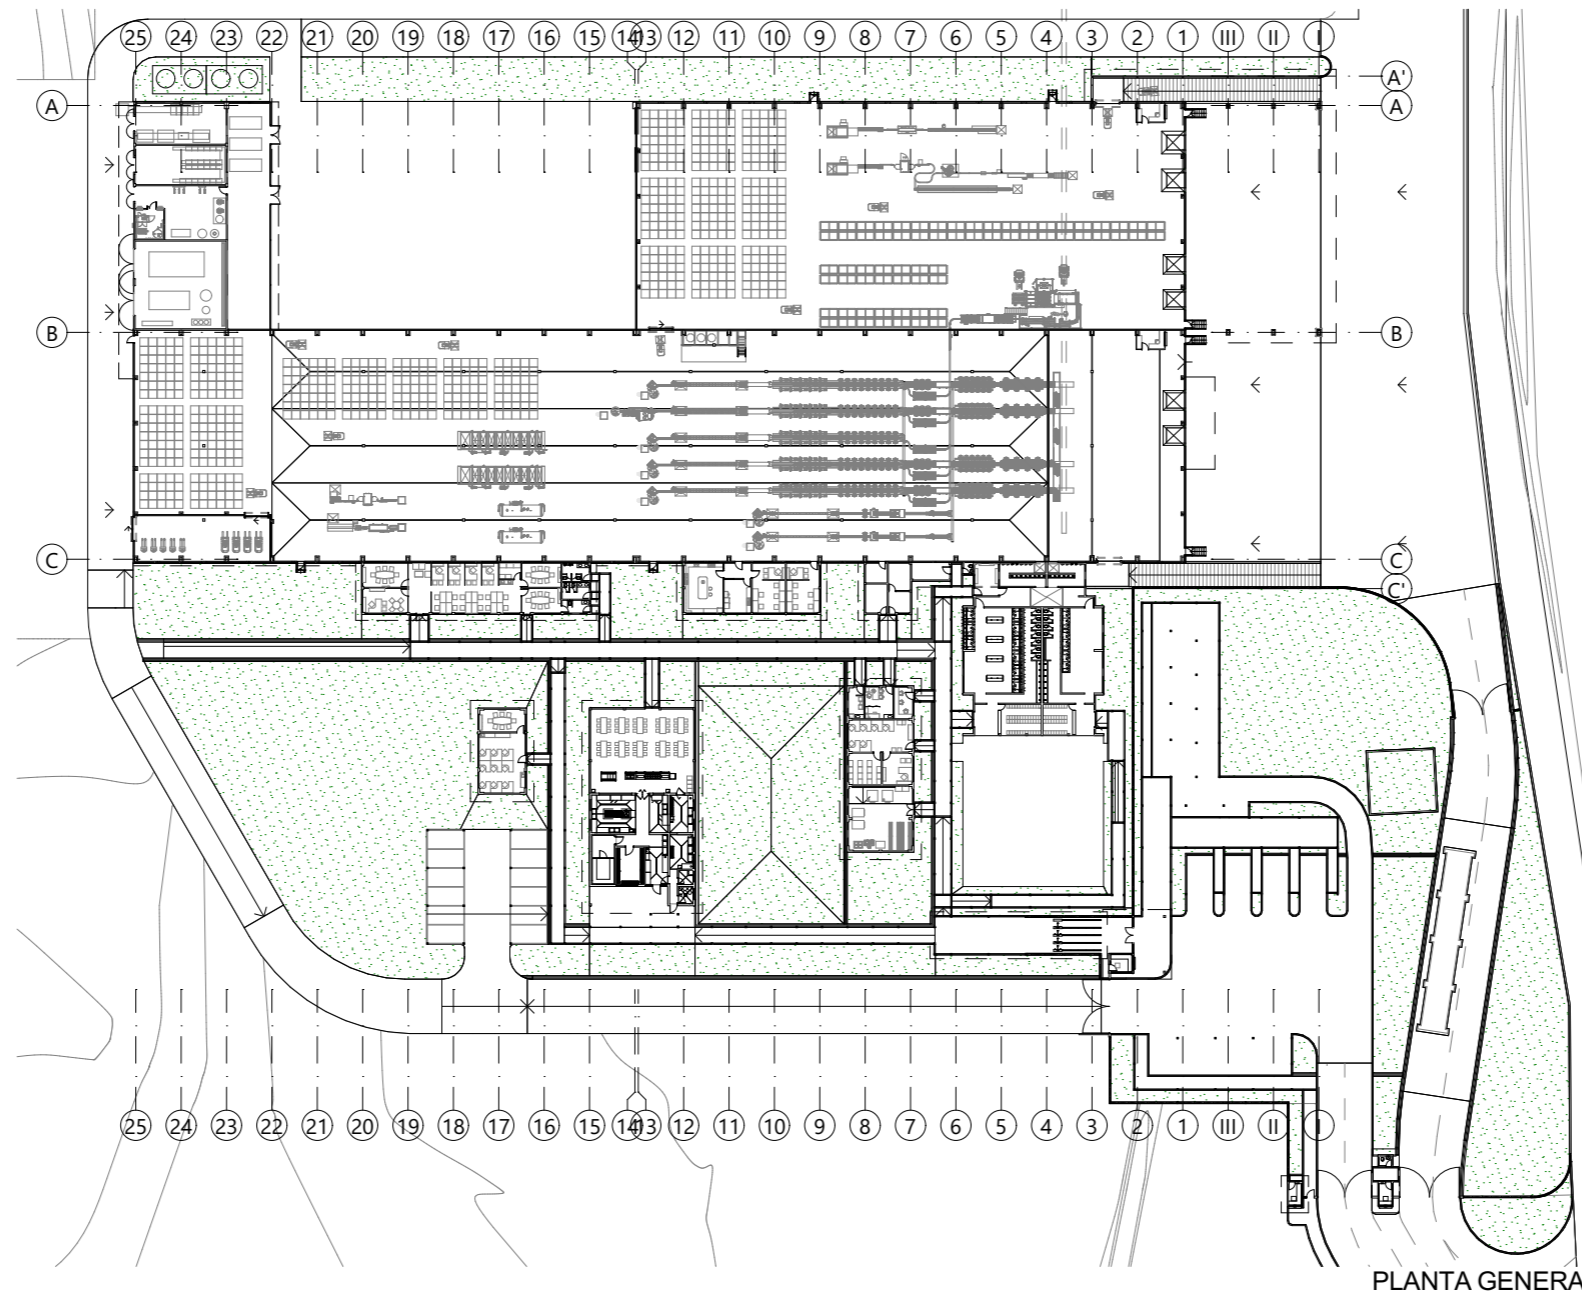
Planta empacadora de palmito – Vista panorámica del proyecto
